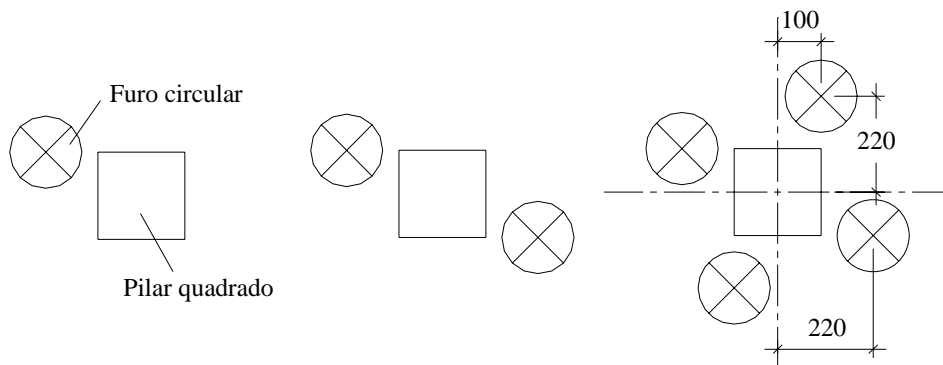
Disposição dos furos em relação ao pilar nas lajes de GOMES e ANDRADE (1995) (mm)
